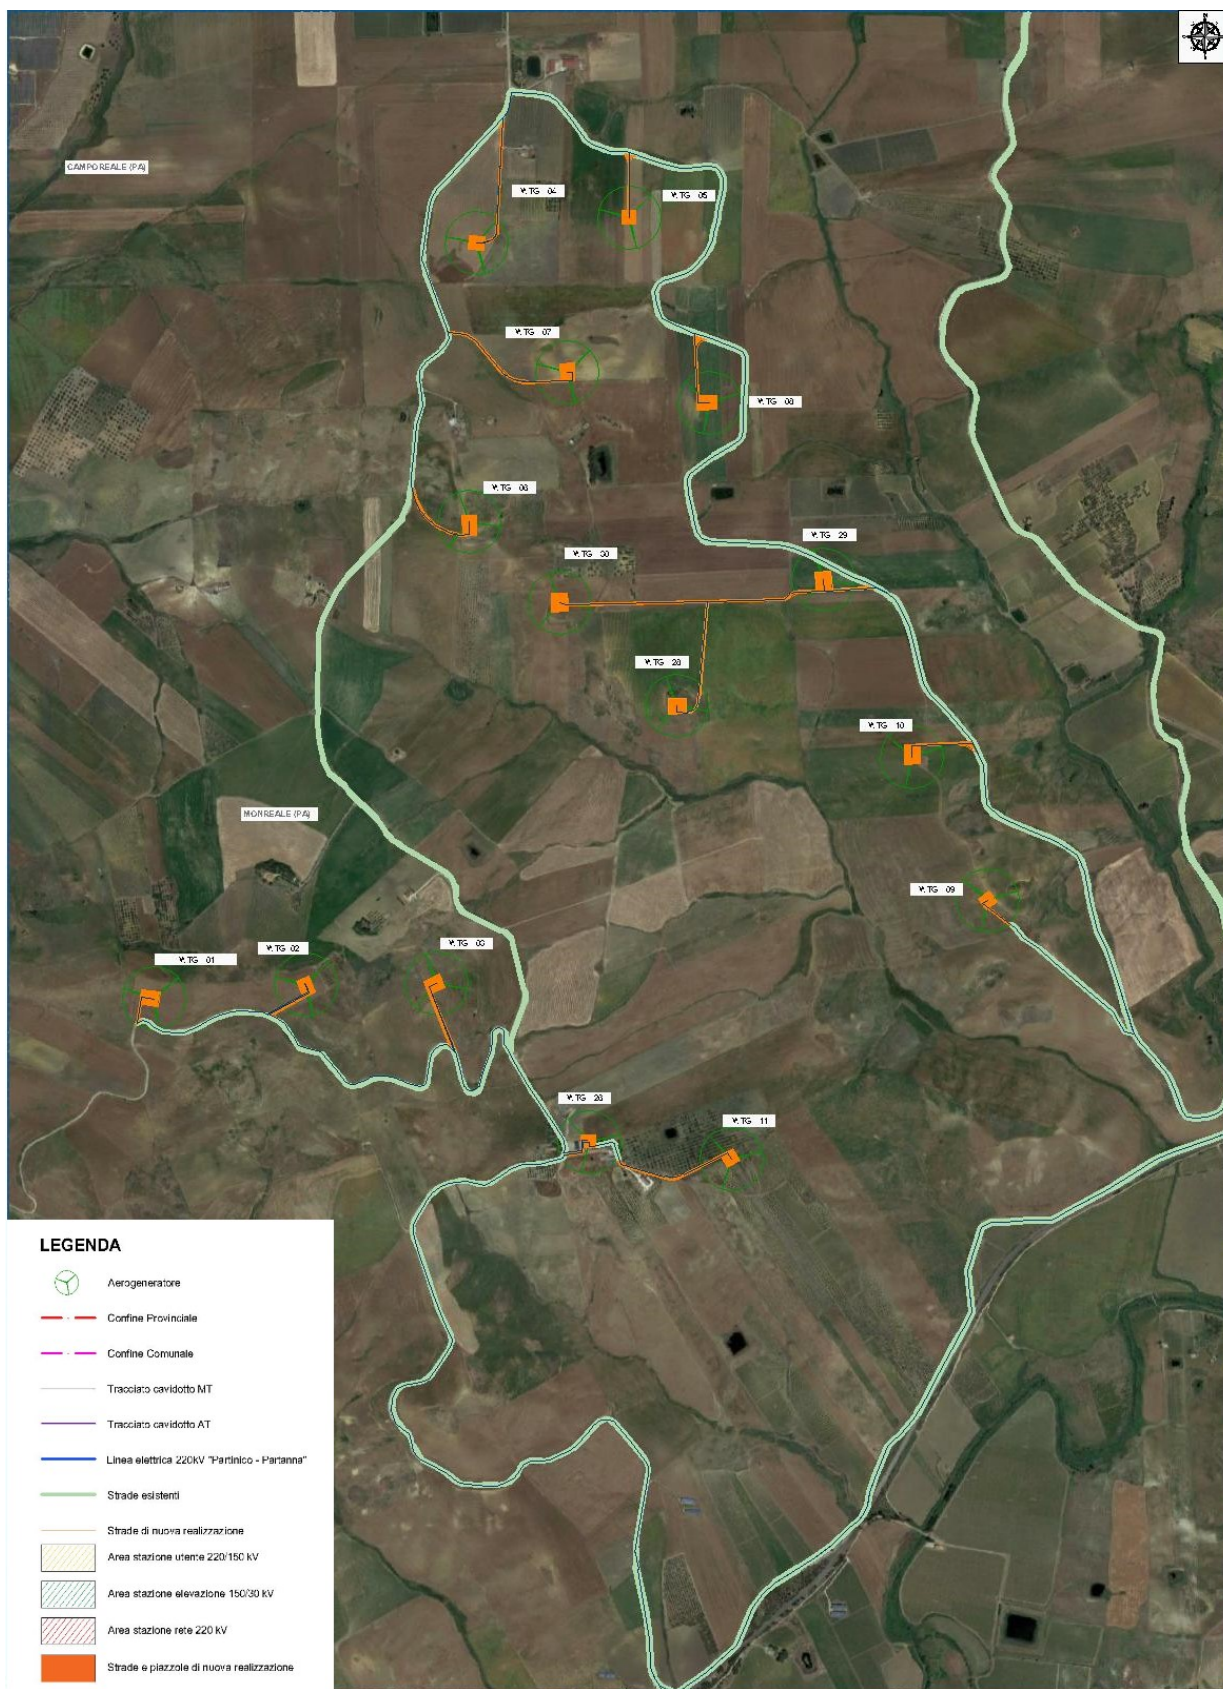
Ortofoto dell'area di impianto ricadente in Contrada Parrino e Pitarre
